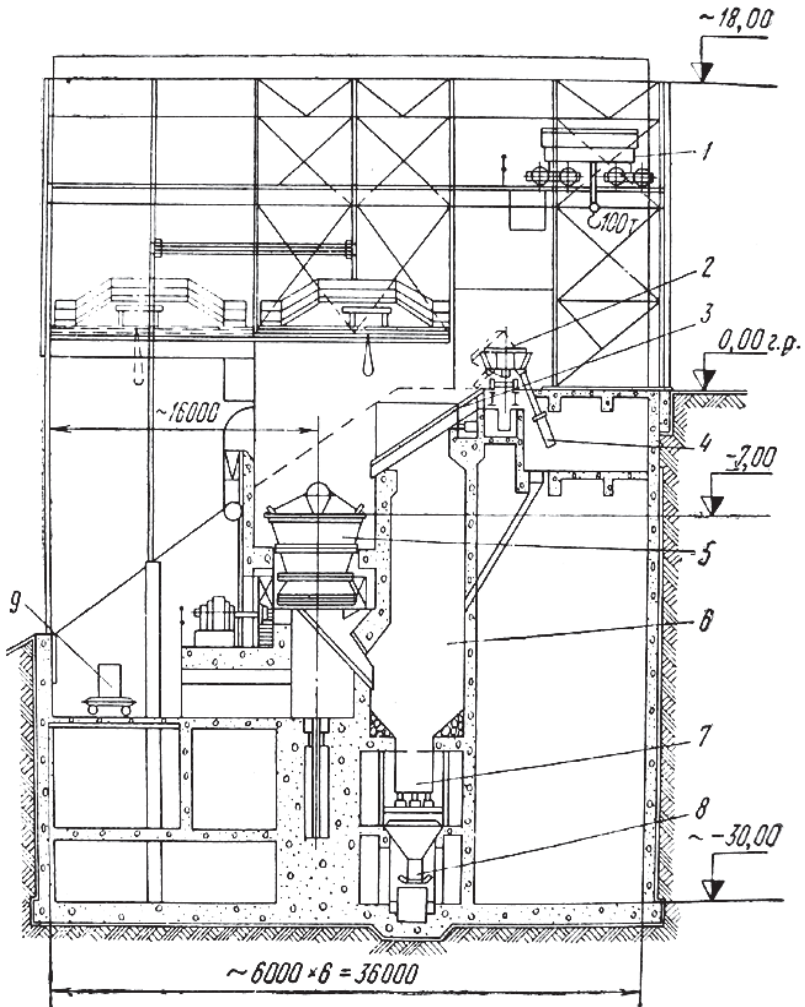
Разрез дробильного цеха с дробилкой ККД-1200:
